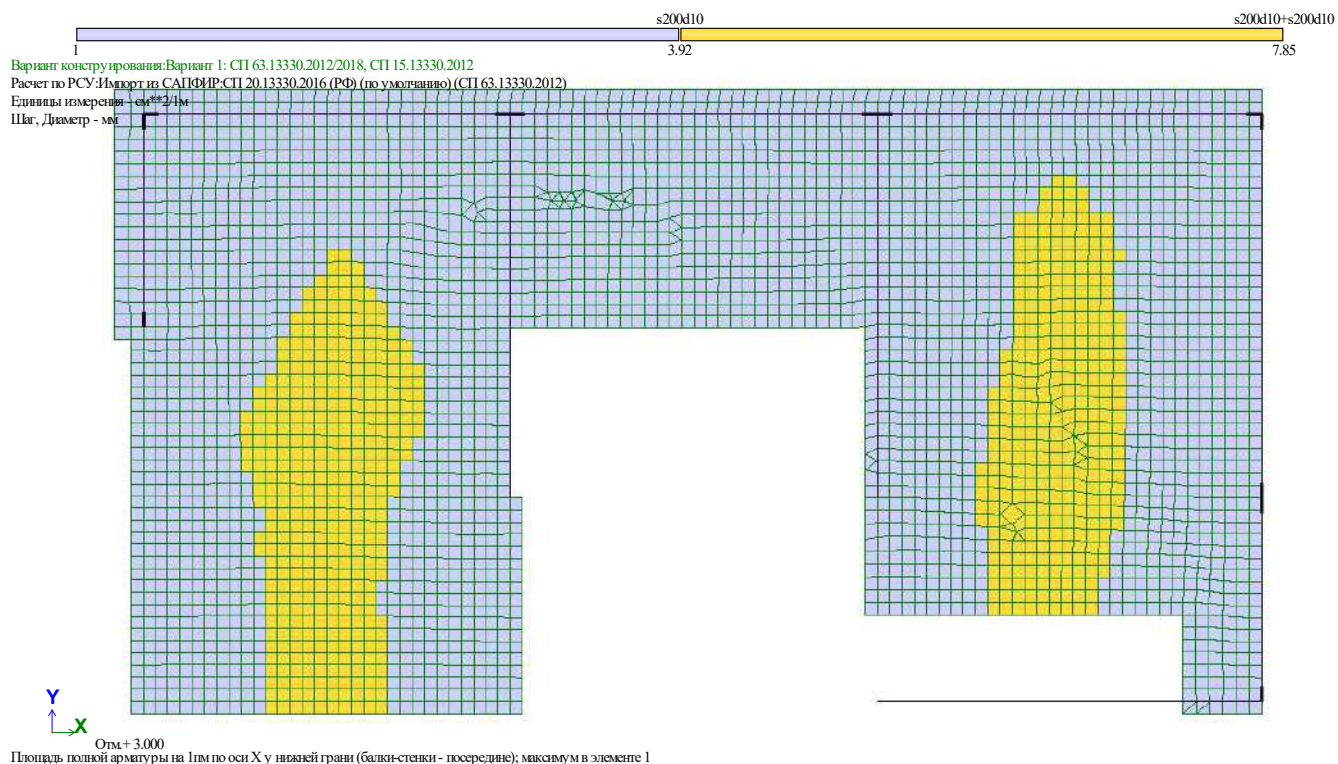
Мозаика армирования нижней арматуры вдоль б.о.
